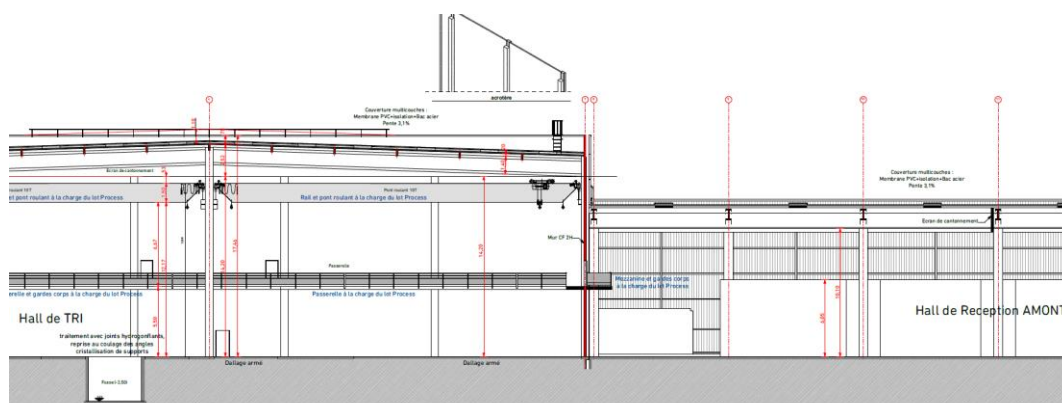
Vue en coupe séparation du hall amont et hall process par un mur REI 120 coupe-feu 2H en dépassement en toiture (source : Trinovia)
